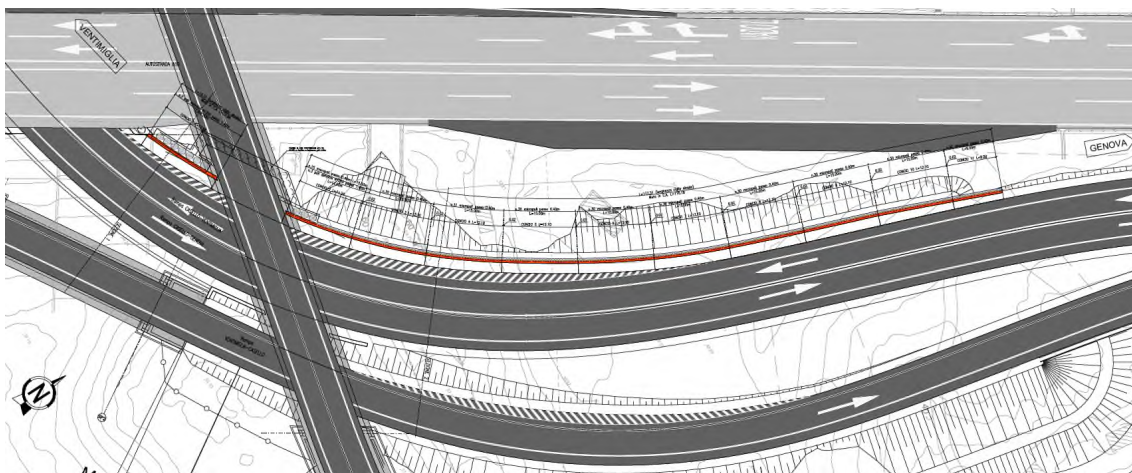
Planimetria ramo Genova – Casello_da sottovia a Casello
